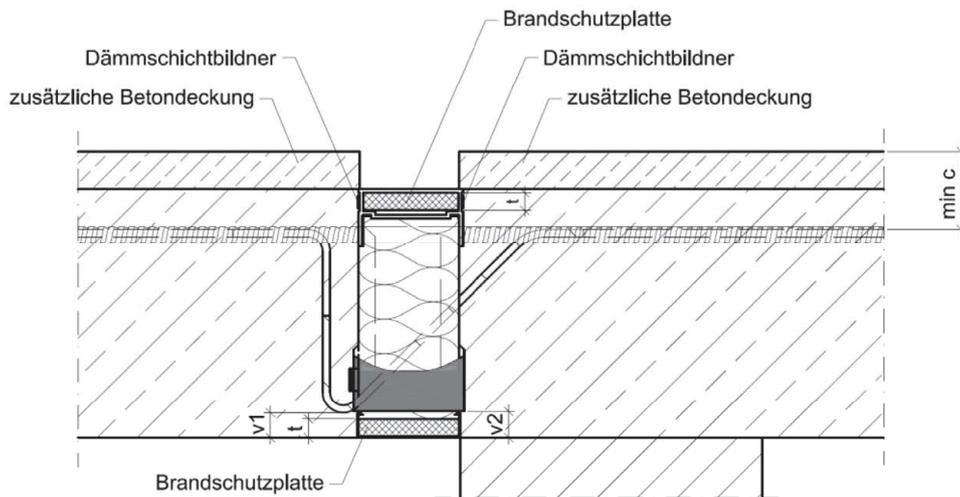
Schöck Isokorb® CXT/CT Feuerwiderstand gem. Abschnitt 3.1.2 mit zusätzlicher Betondeckung
